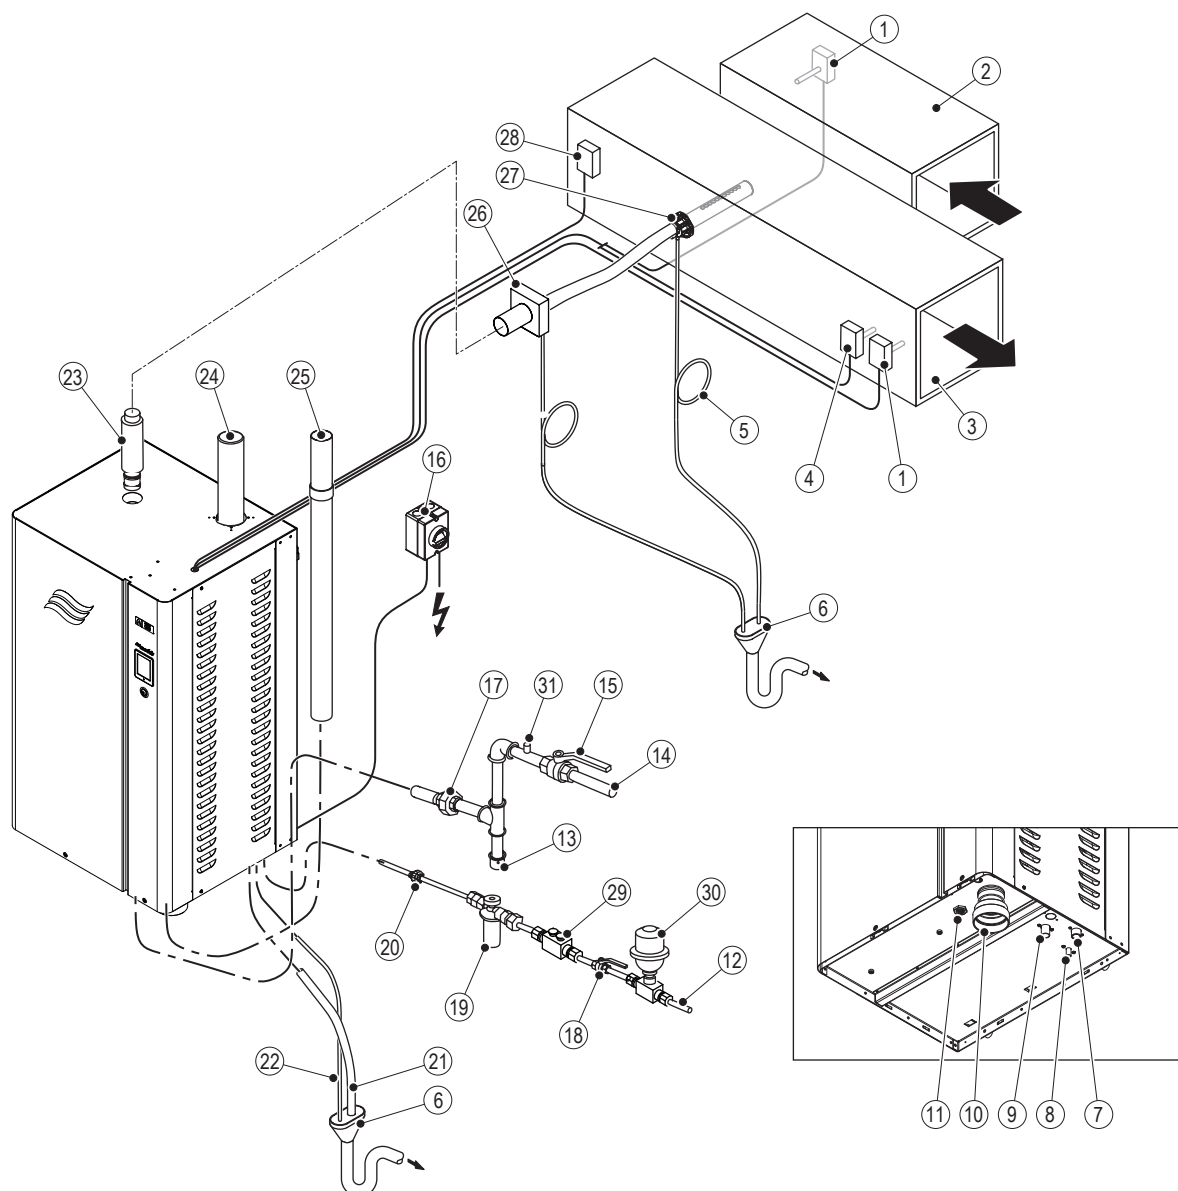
Vue d'ensemble du système des unités compactes GS 23/45
